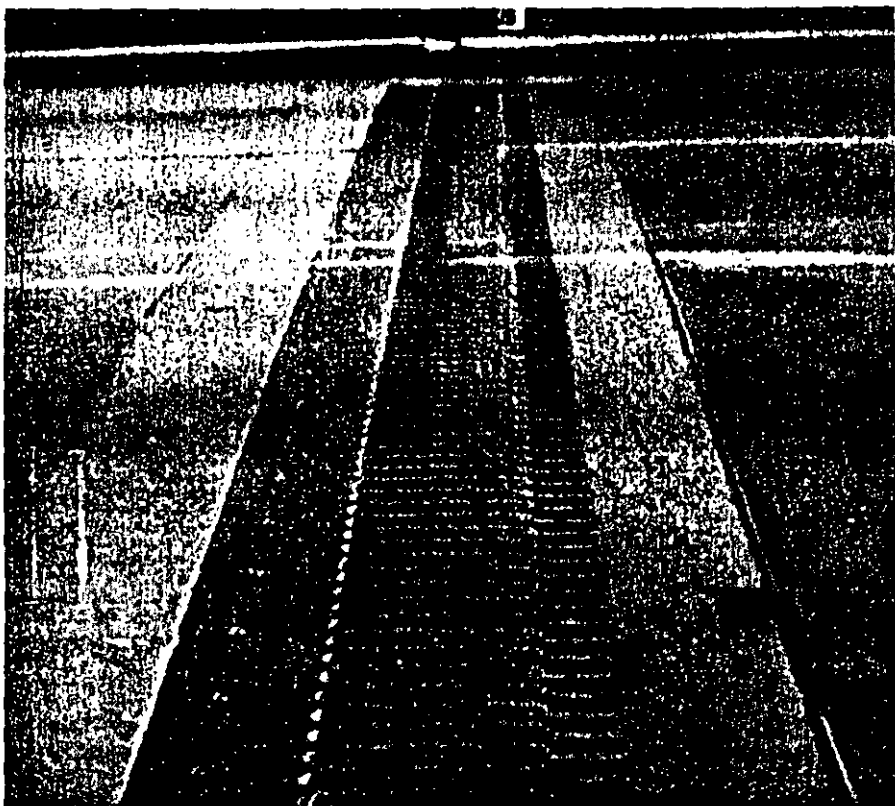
Dispositivo de dilatación de placa con barras salientes (dedos), en el estribo oeste del puente en la calle Alamo.
